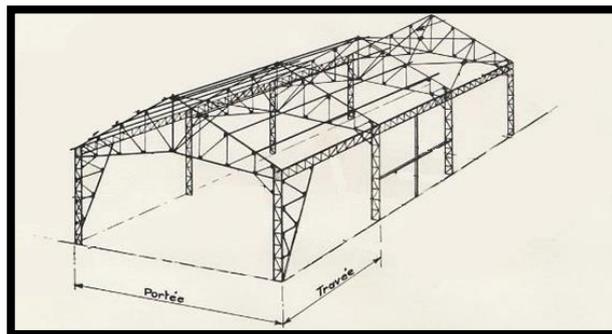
poteaux et poutres en treillis<sup>193</sup>
